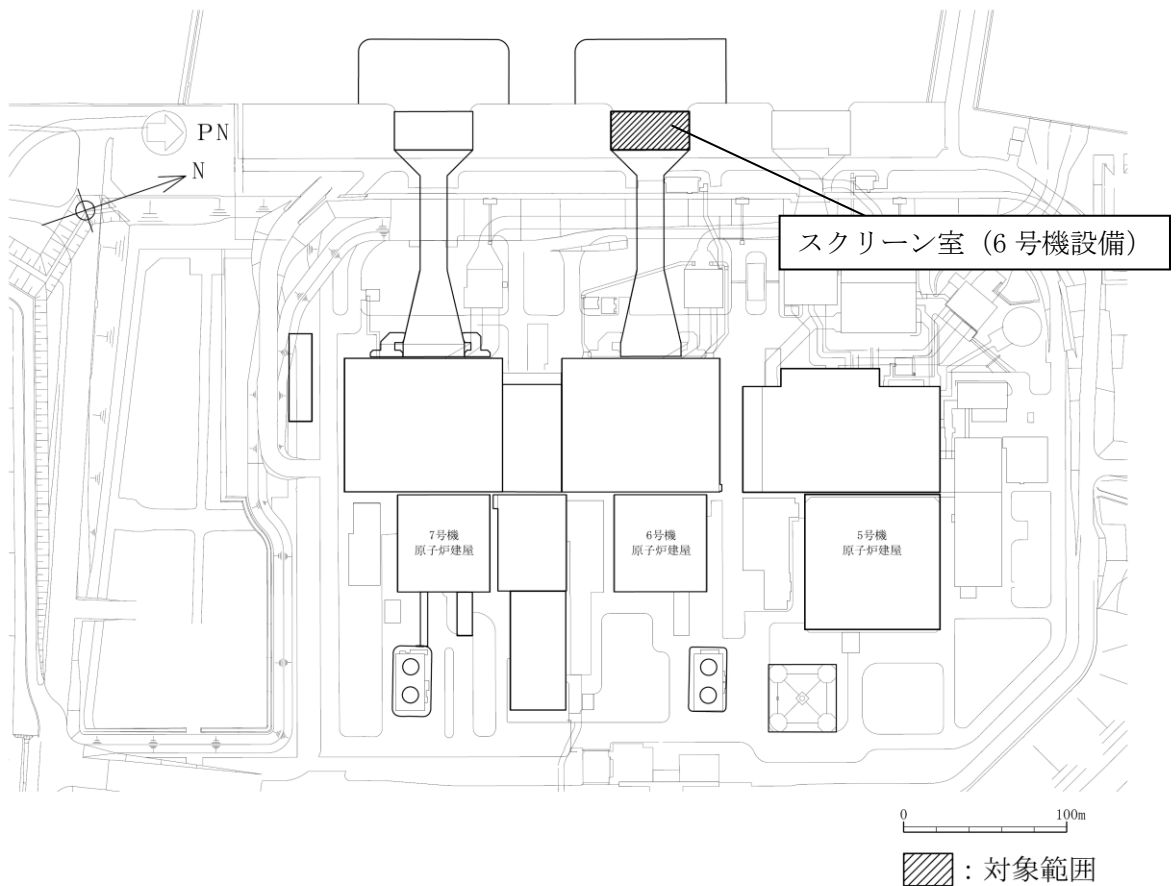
スクリーン室（6号機設備）の平面配置図（平面図）
